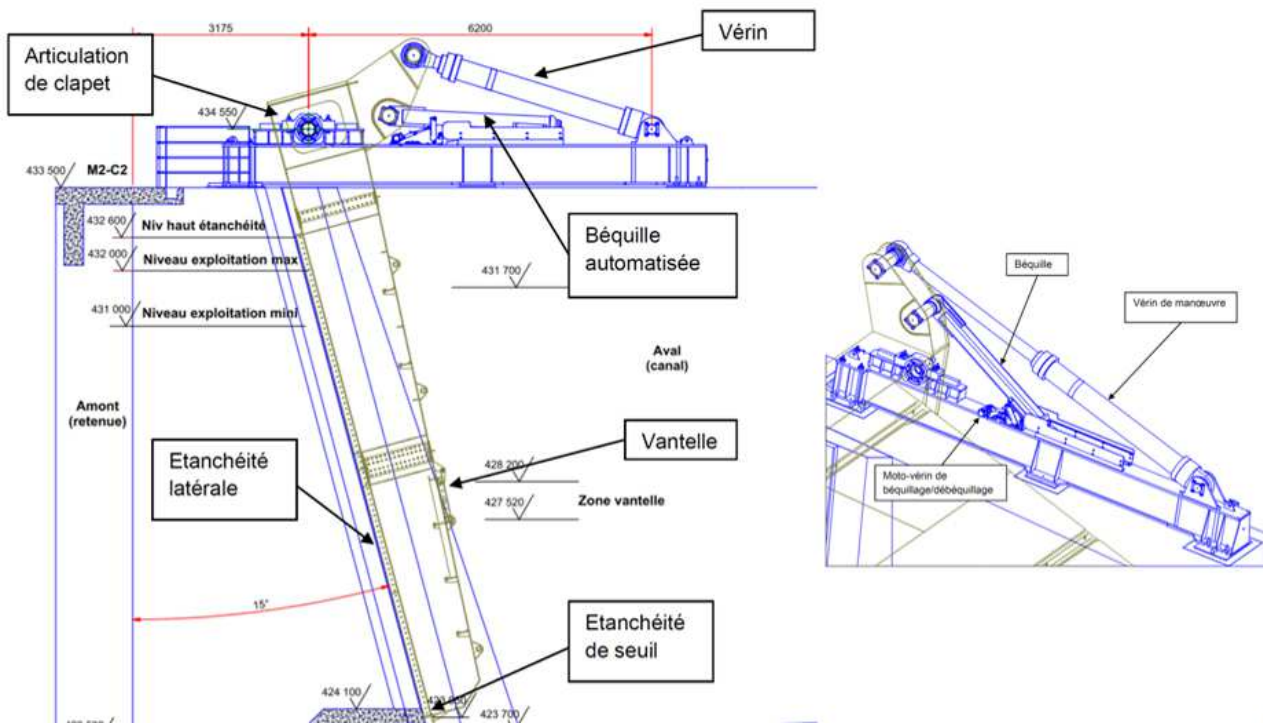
Vue en coupe : Clapet fermé (15°/verticale) Photo 5 : Vue d'ensemble châssis de rive
